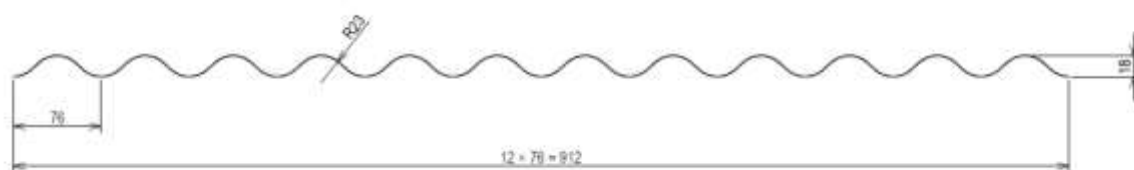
Sezione strutturale del profilo sinusoidale.
